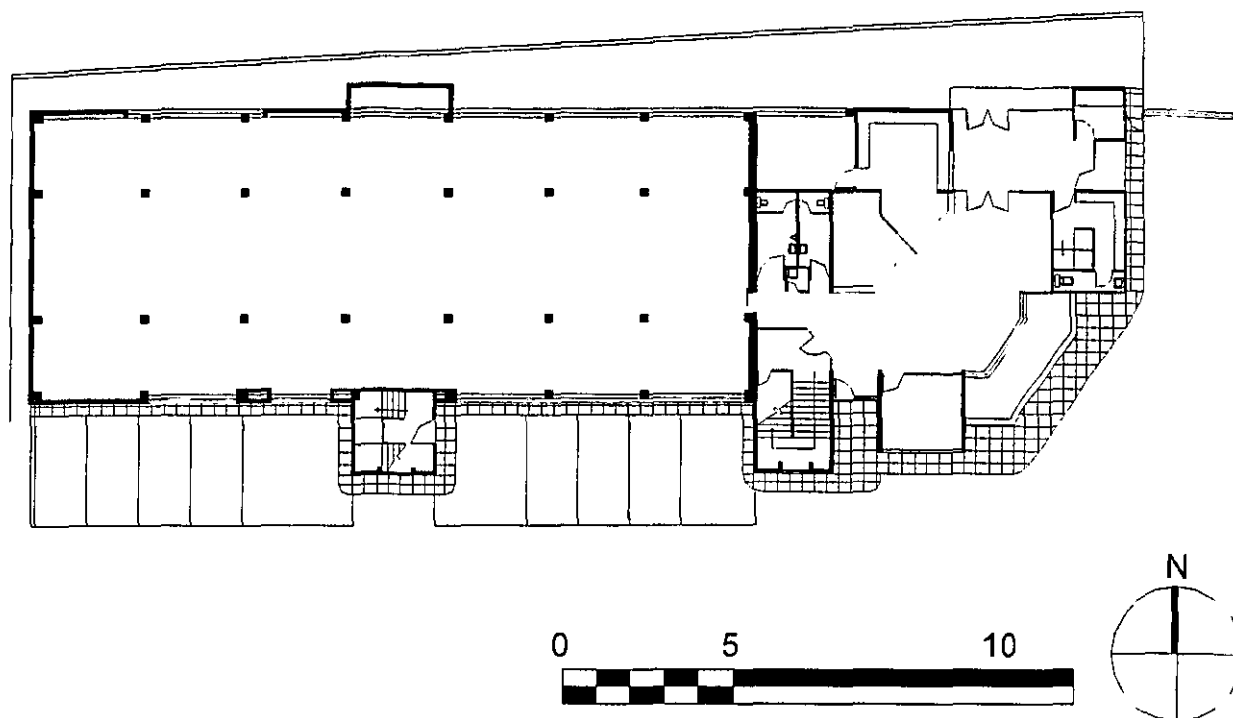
Edificio DISPAMOCUSA, planta arquitectónica (AOV).
